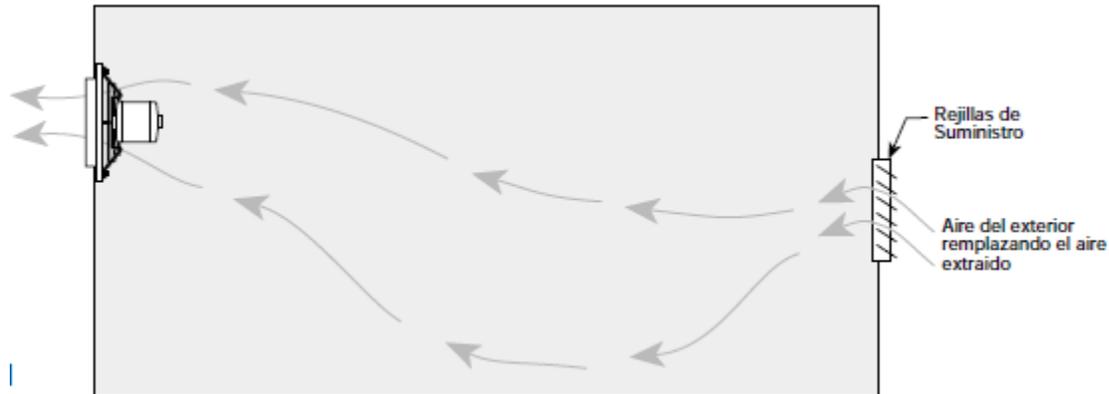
Montaje como extractor a un lado. Fuente (Salvador, 2002)
